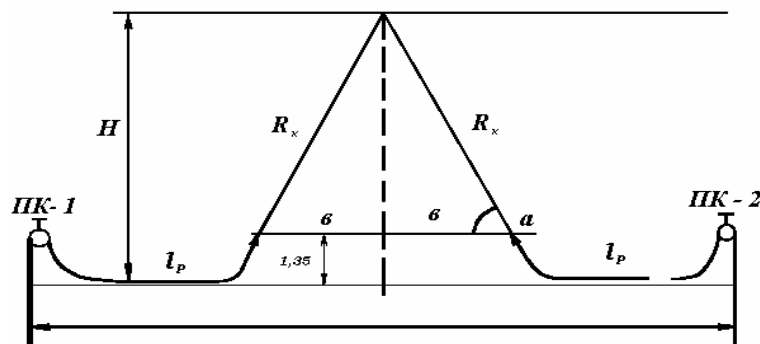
Схема для расчета расстановки внутренних пожарных кранов:
